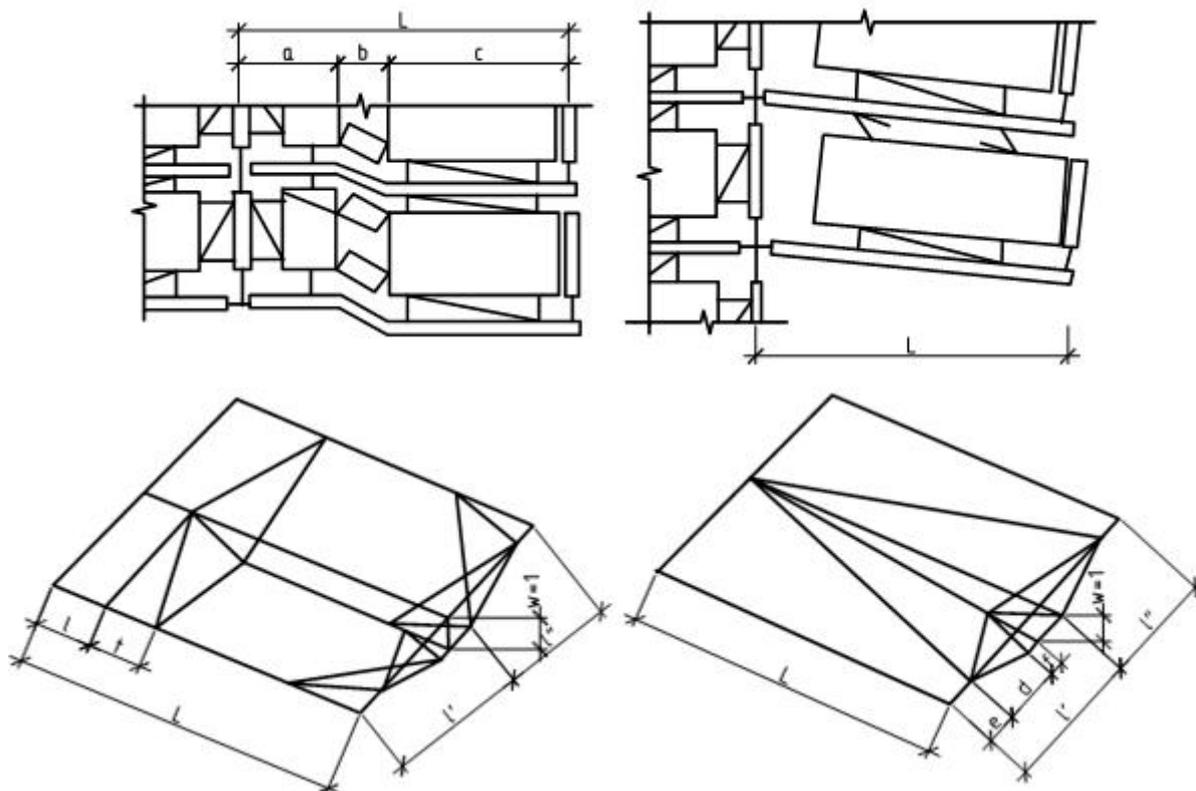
Работа плит перекрытий в зданиях с железобетонными наружными стенами
